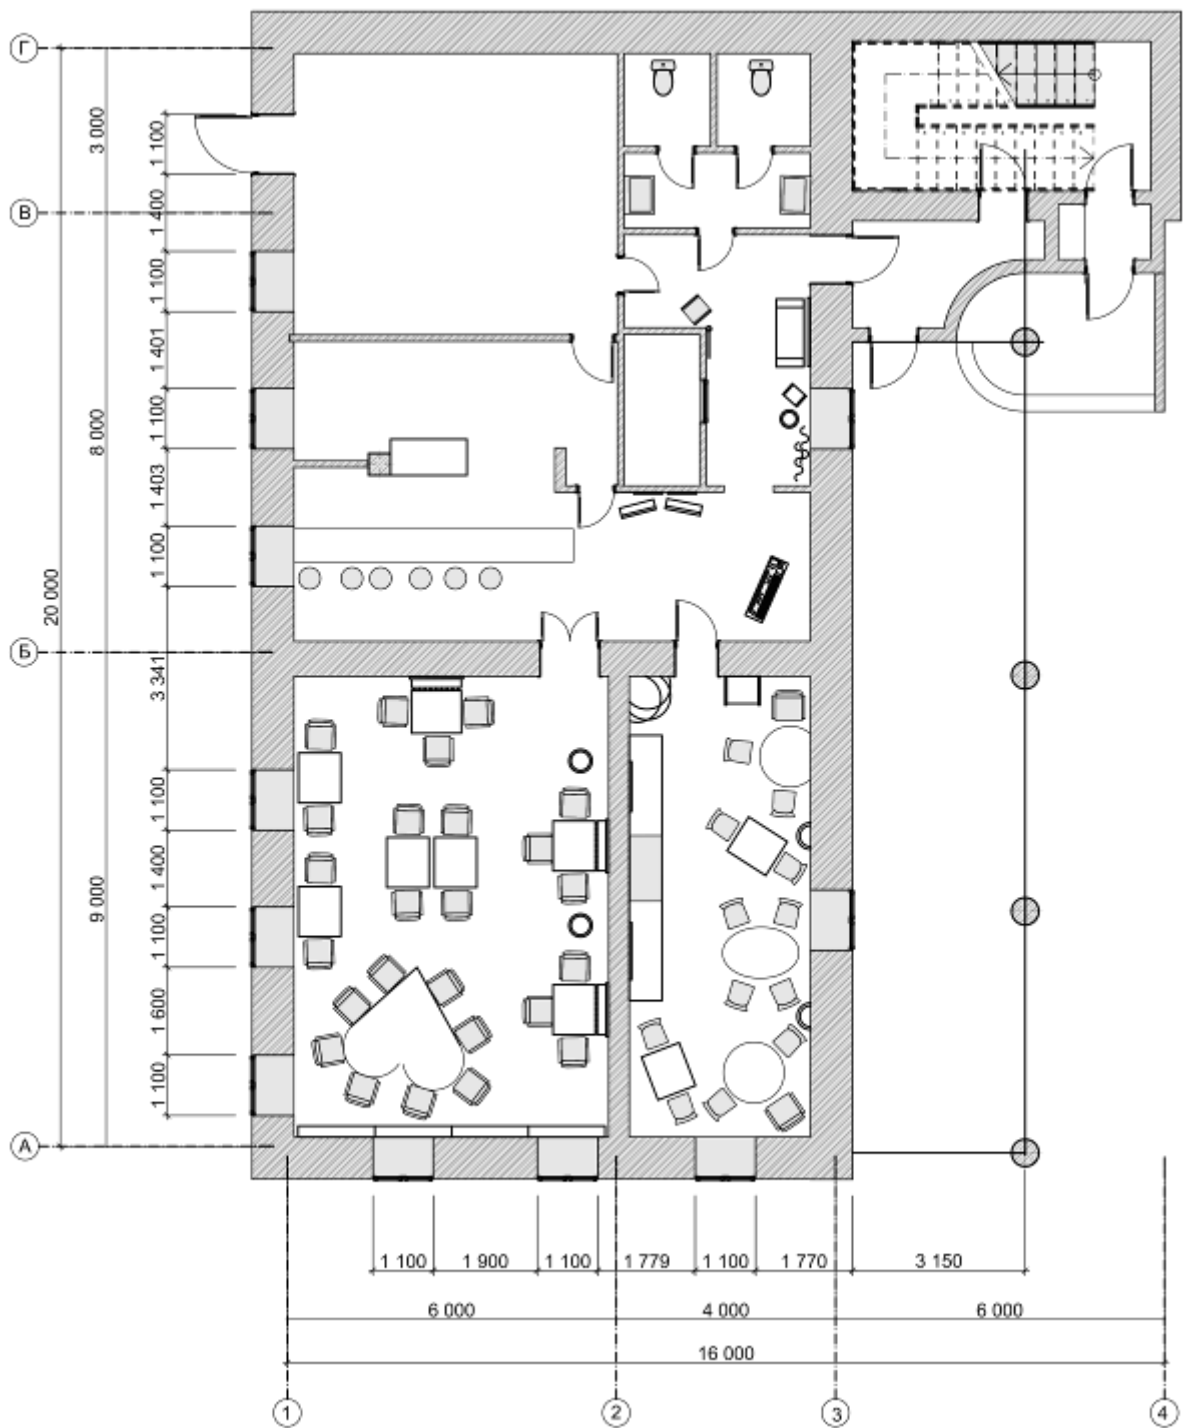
План 1 этажа с расстановкой оборудования
